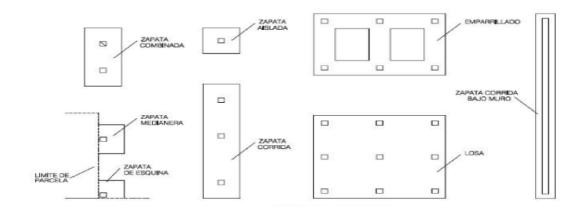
Planta Esquemática de tipos de cimentaciones directas.
